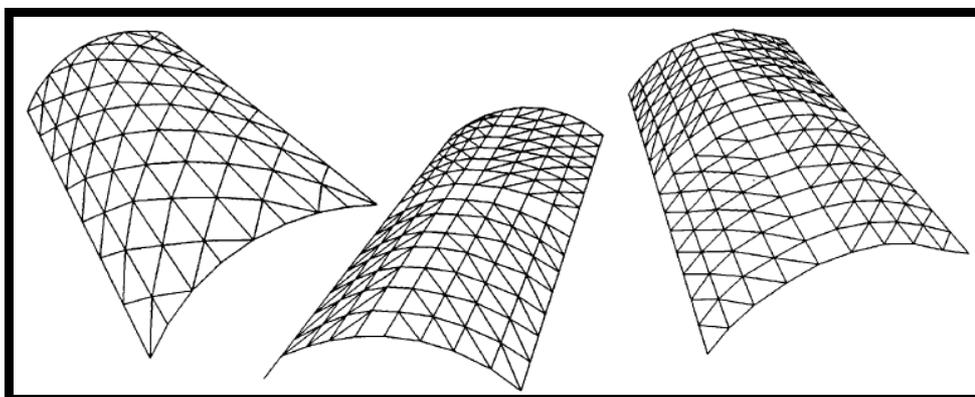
Exemplos de estruturas reticuladas espaciais em abóbadas
